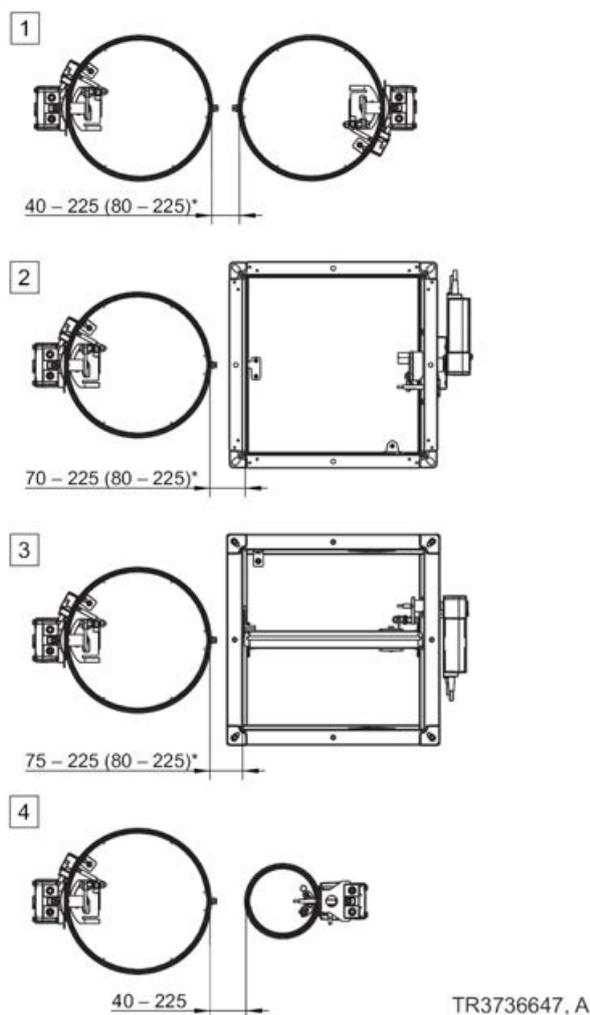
Distance entre le FKR-EU et d'autres clapets coupe-feu TROX pour un montage à base de mortier
